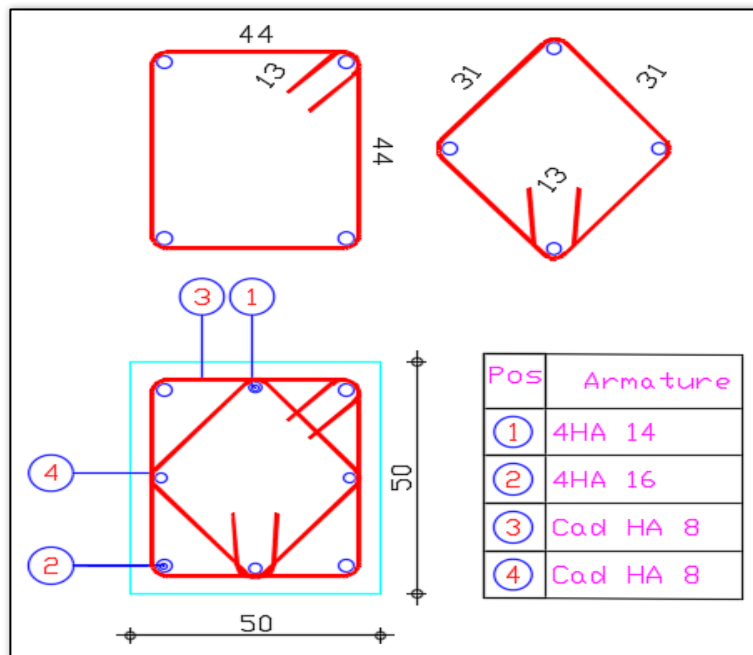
Schéma de ferrailage du tirant selon l'EC2.
